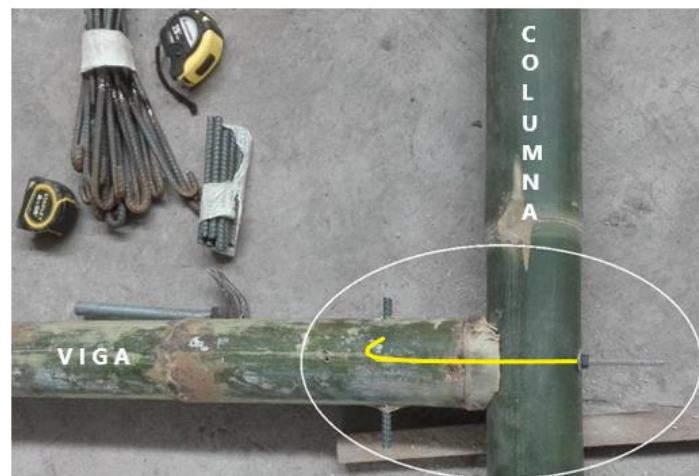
Detalle de la modificación a la conexión Simón Vélez utilizado en las conexiones viga - columna de la estructura espacial hexagonal.
